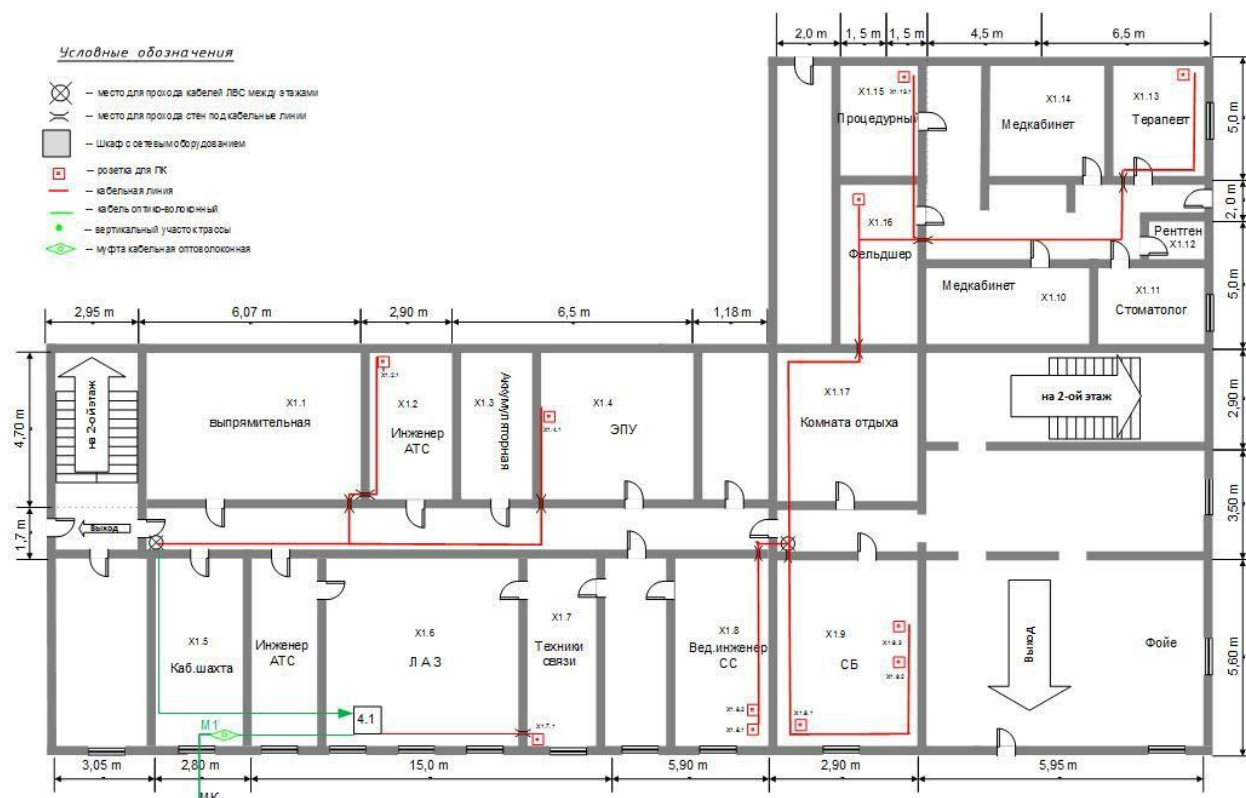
Схема прокладки СКС (1 этаж)
